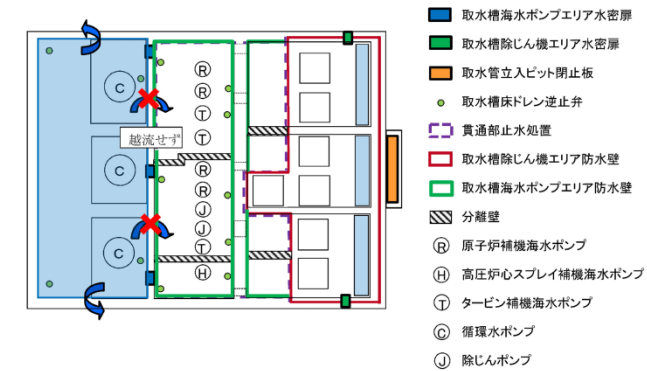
取水槽海水ポンプエリア平面図 (循環水系配管破損時)
